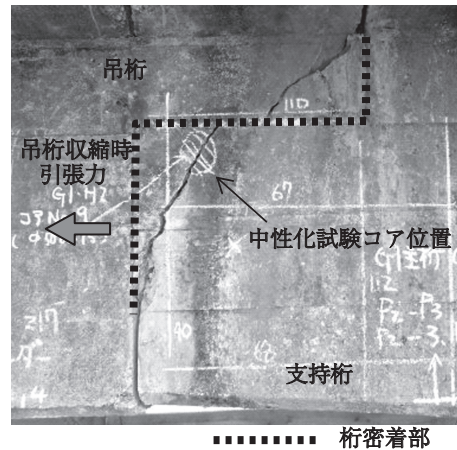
ゲルバーヒンジ部ひび割れ状況
